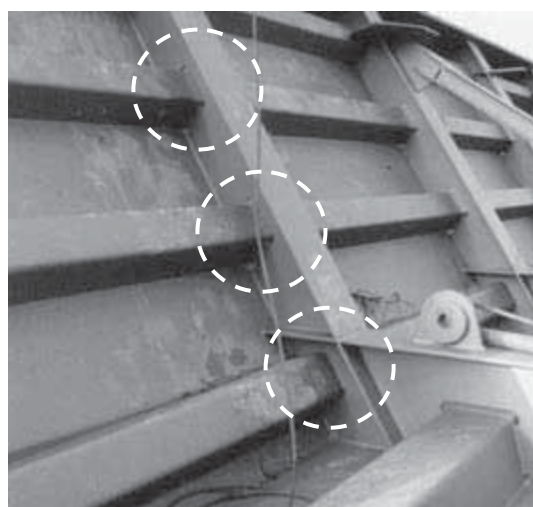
Détail constructif de l'intersection entre raidisseur longitudinal et cadre de contreventement
